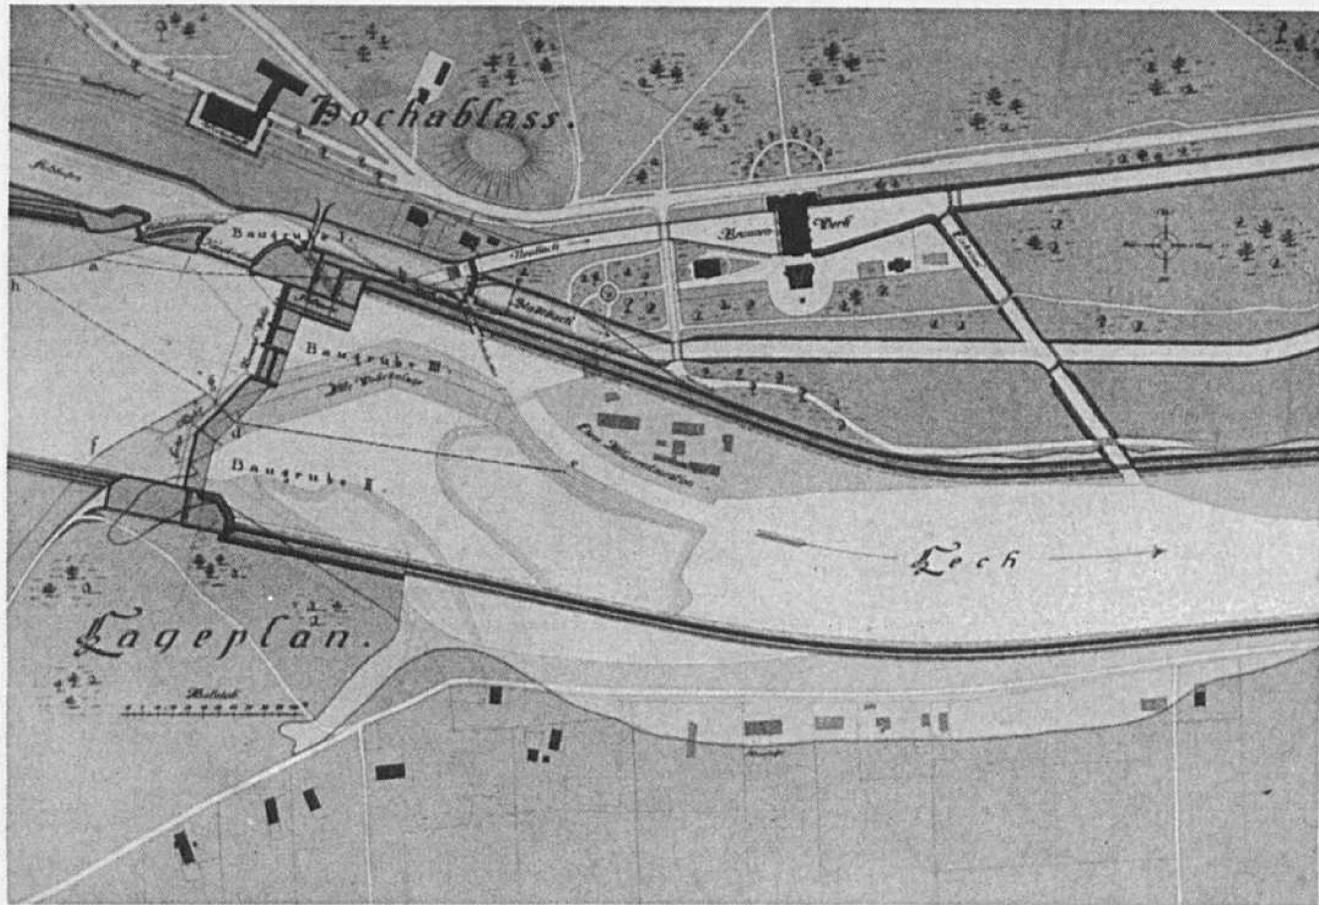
Lageplan des Hochablaßwehres von 1912 (angedeutet ist auch das alte Schrägwehr mit Floßgasse, vor 1910) und des Wasserwerks von 1879 (oben Mitte). Norden rechts.
